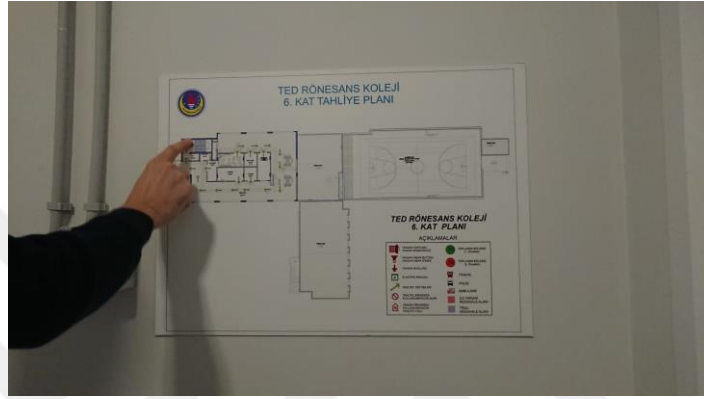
TED Rönans Koleji vaziyet planı.
